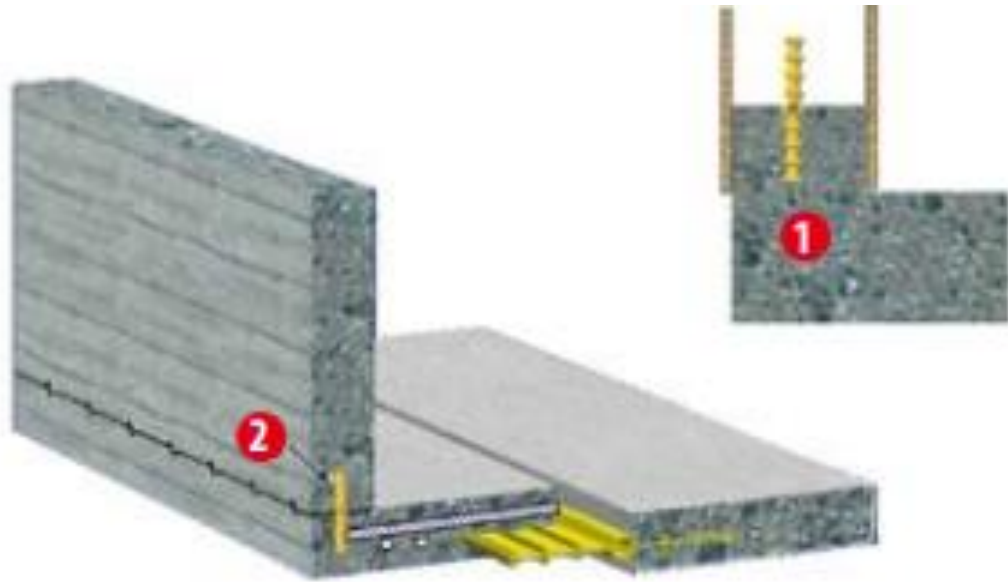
Detalle de instalación de cinta PVC en la junta de construcción. Fuente: Sika Informaciones Técnicas. Construcción de Estructuras Impermeables y Estancas.
